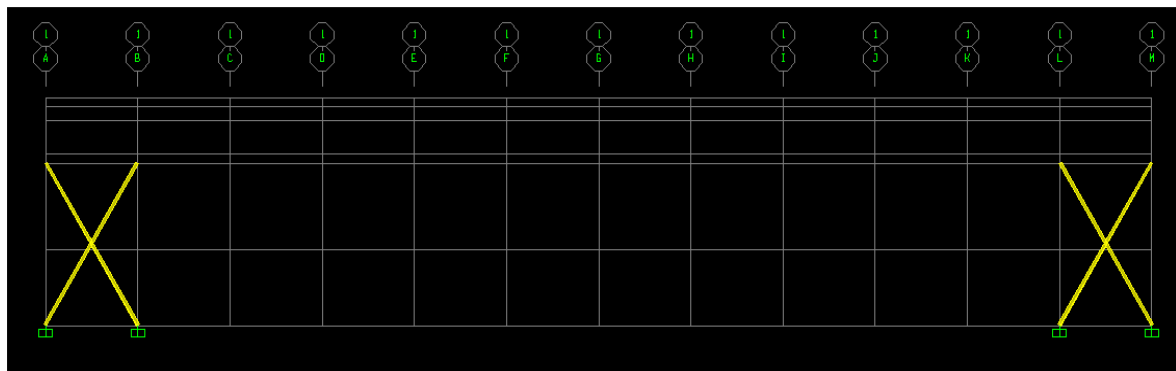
vue en plan YZ de contreventements sur le long-pan
